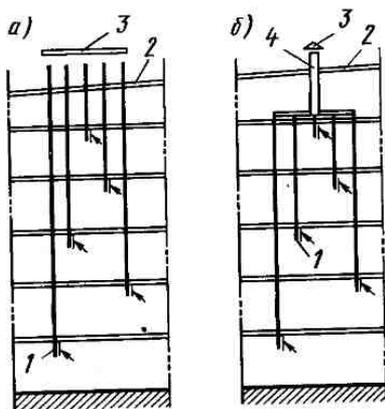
Схемы системы вытяжной вентиляции с вертикальными каналами:
